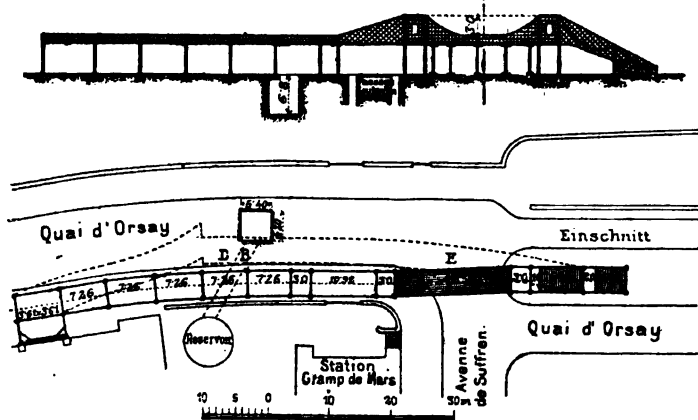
Eingestürzter Stäg nach dem „Globe céleste“.
